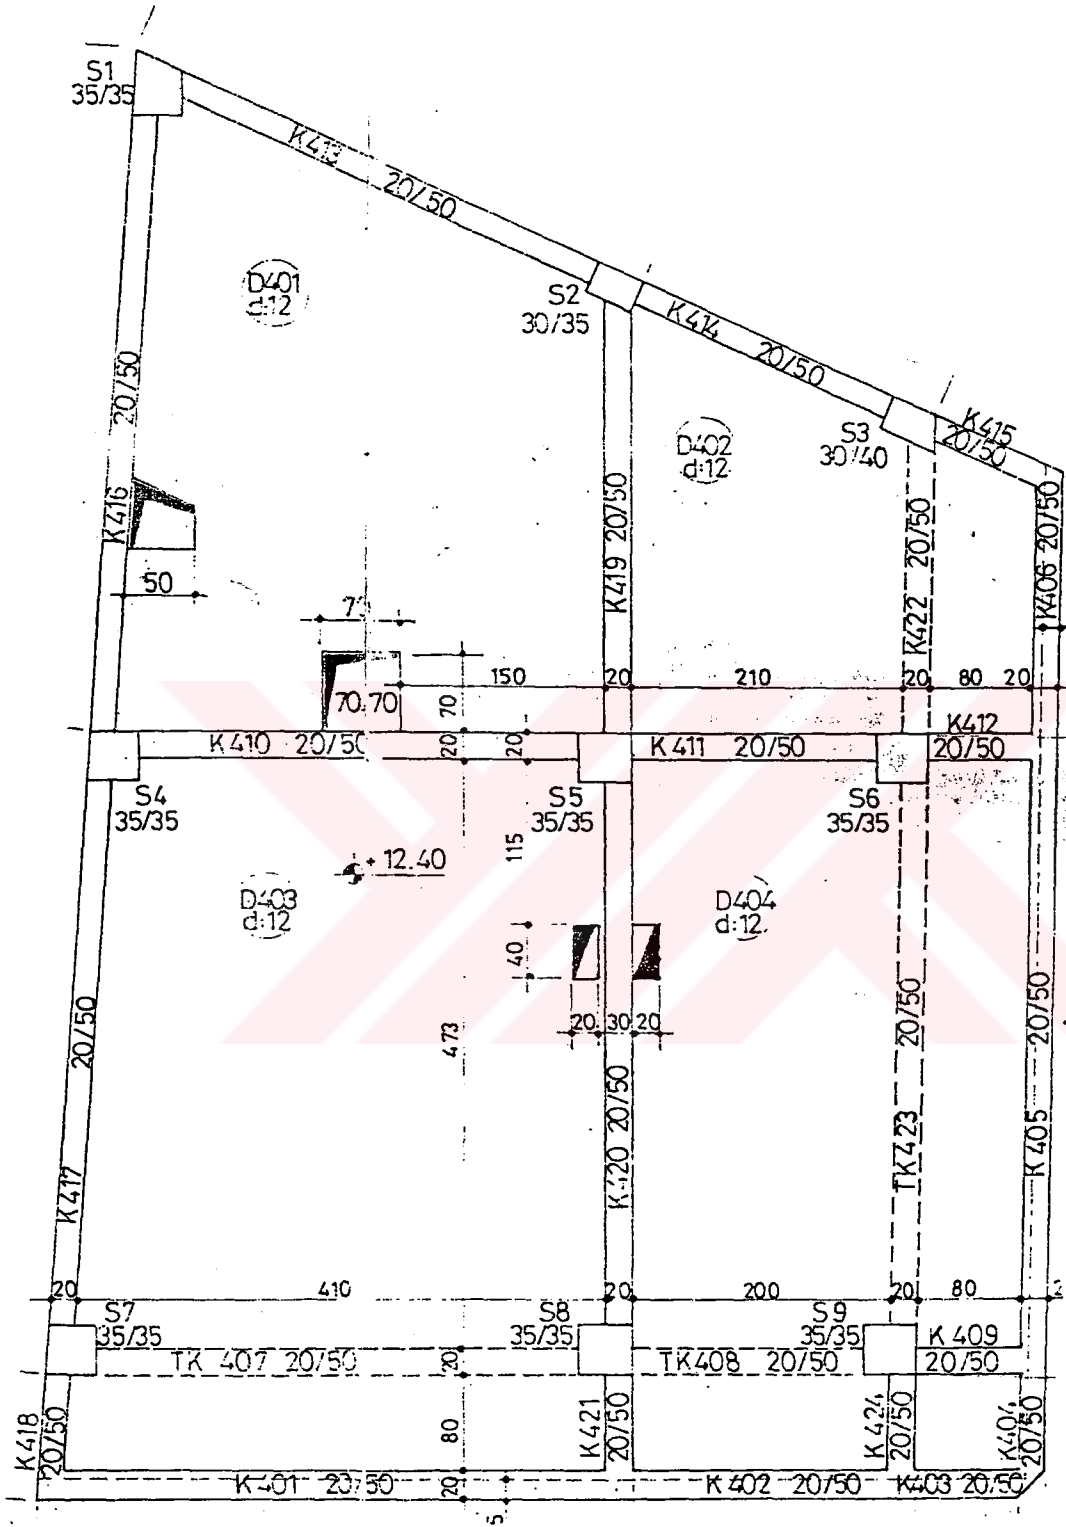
Bodrum Kat Tavanı Kalıp Planı
